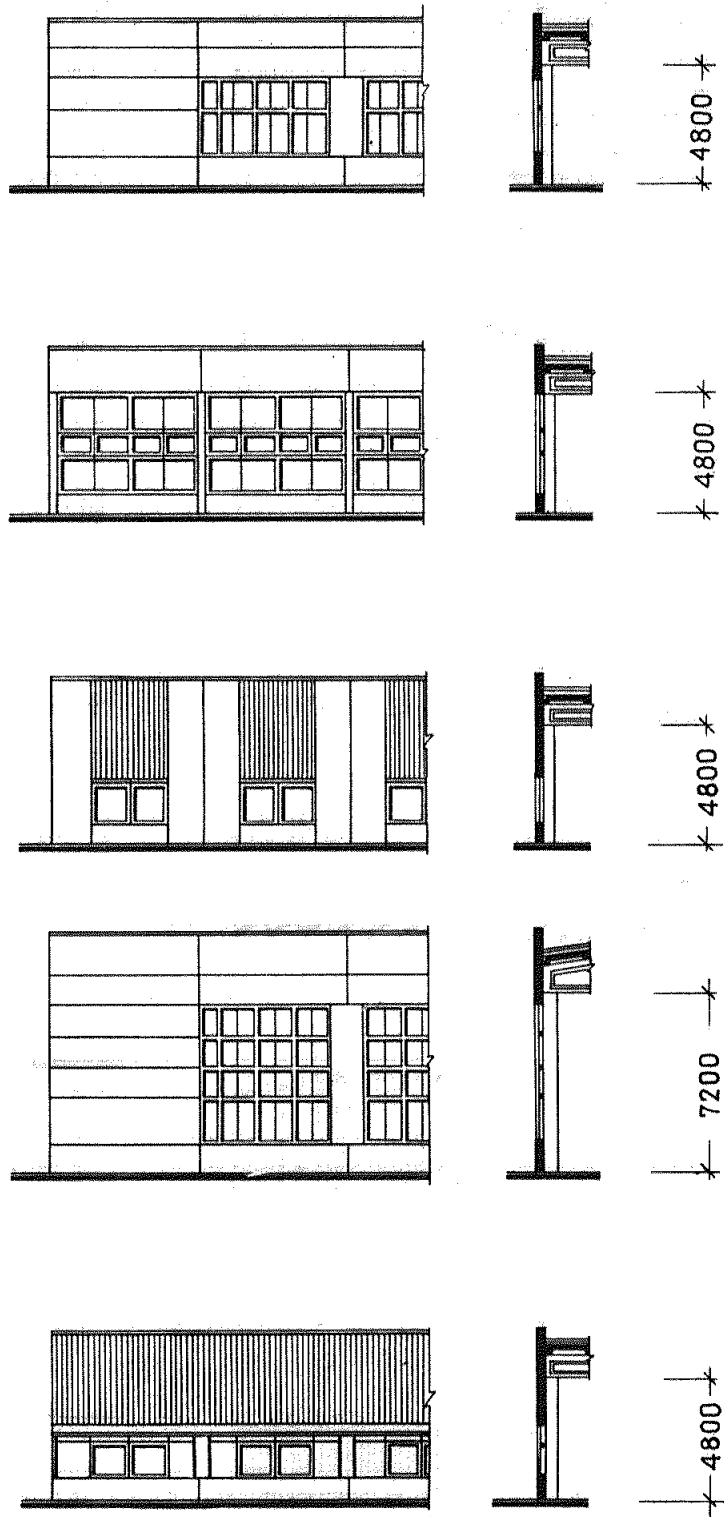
Примеры решения стен одноэтажных производственных зданий
